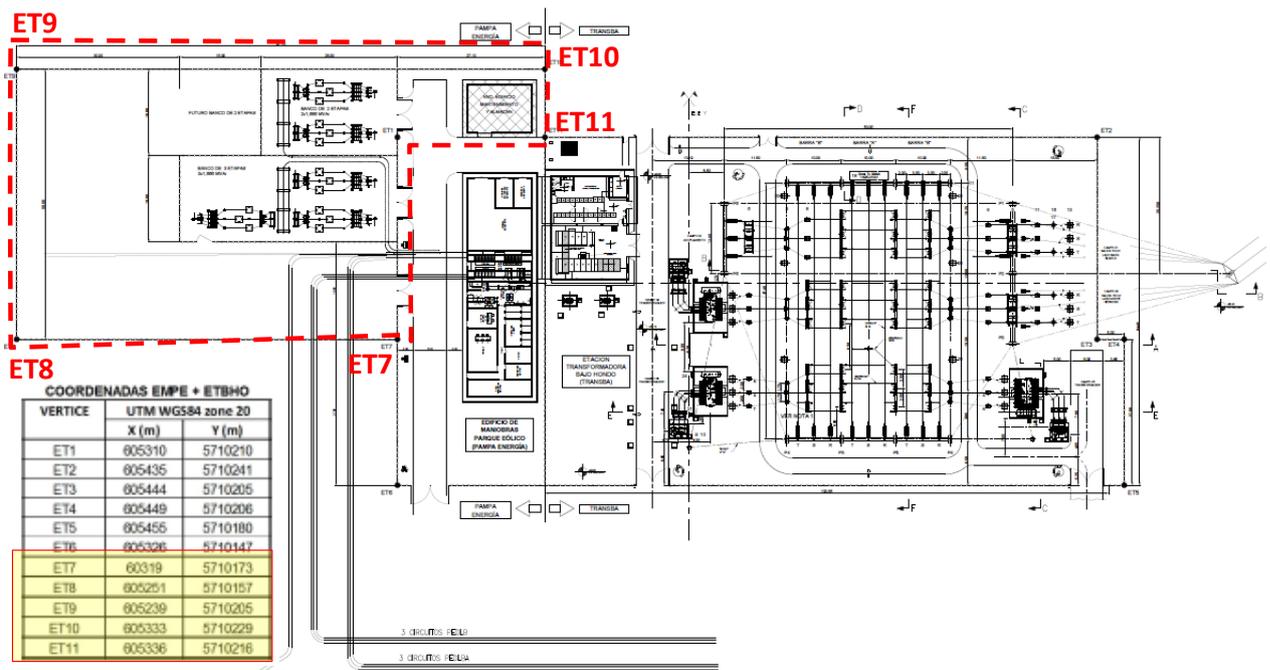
Planta General de la ETBHO, EMPE y áreas asociadas al proyecto.
